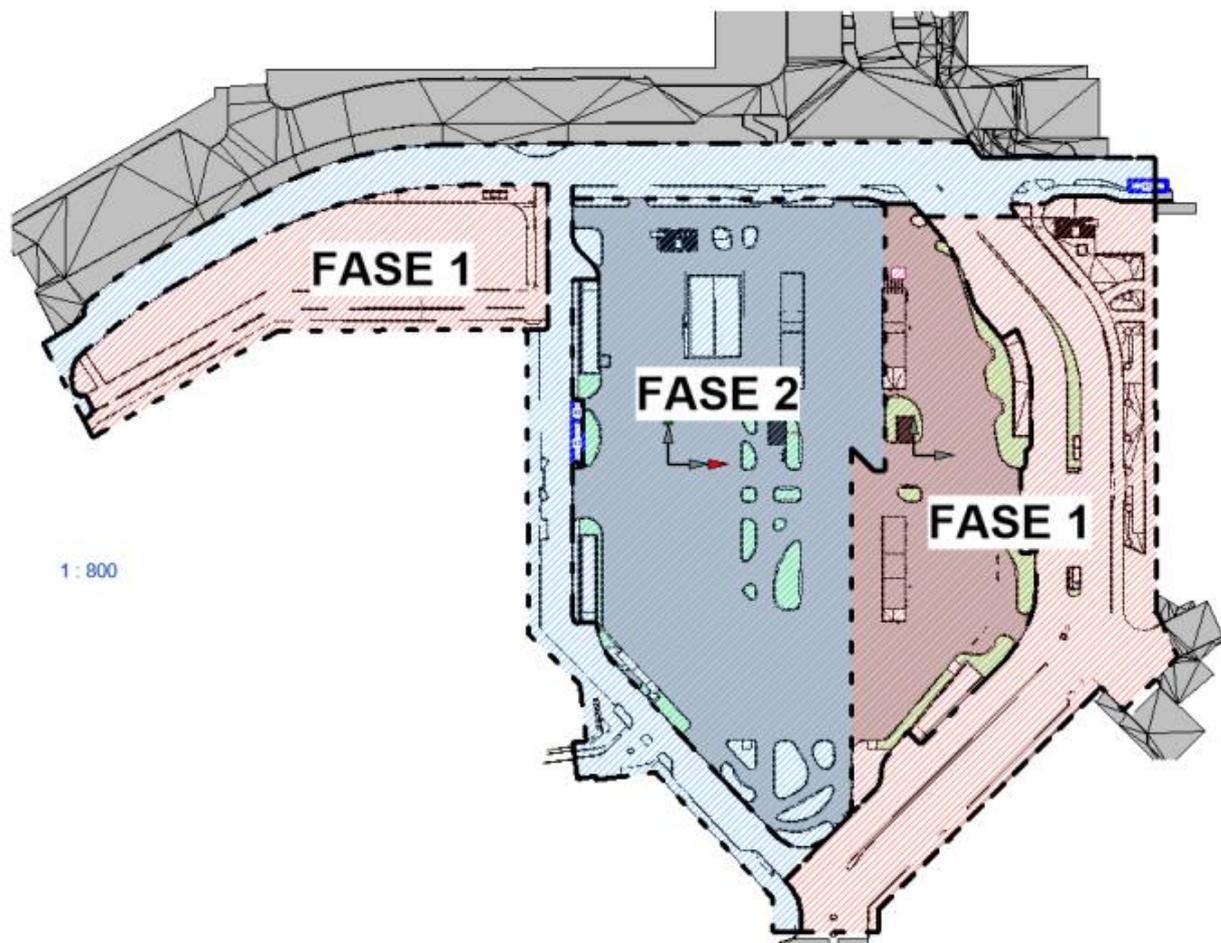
Schema planimetrico suddivisione di superficie tra fase 1 e fase 2
